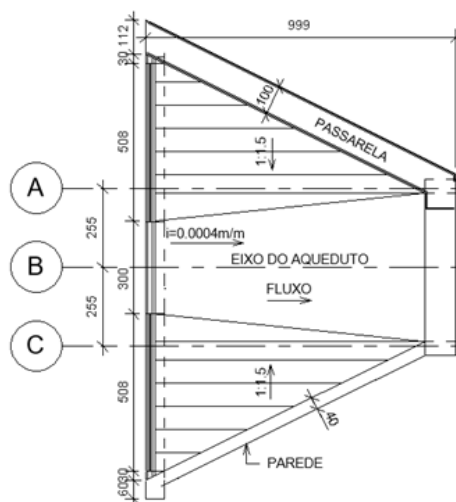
Estrutura de transição do Aqueduto Xingozinho
